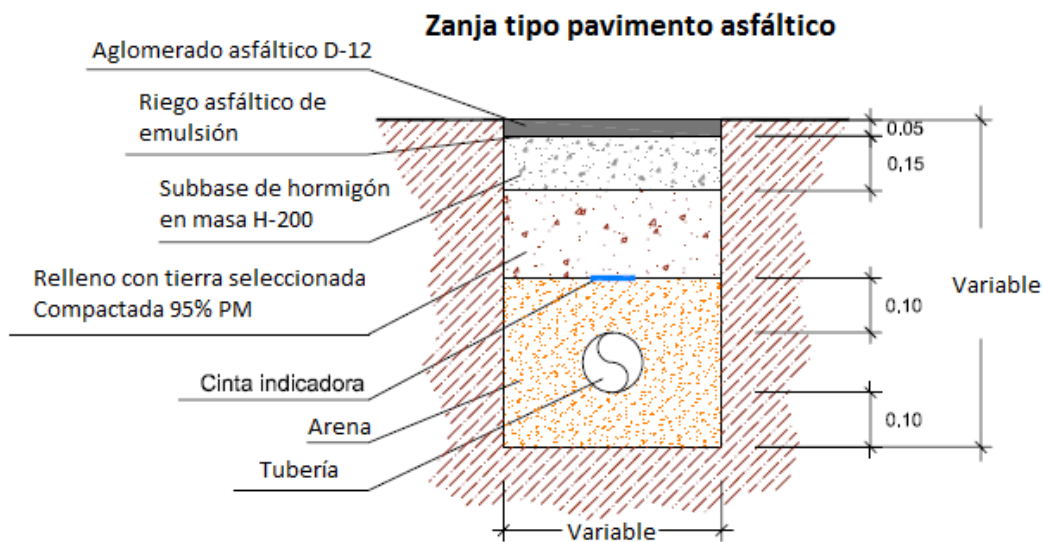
Zanja tipo pavimento asfáltico (dimensiones en metros). [Fuente: SOREA, SAU]
